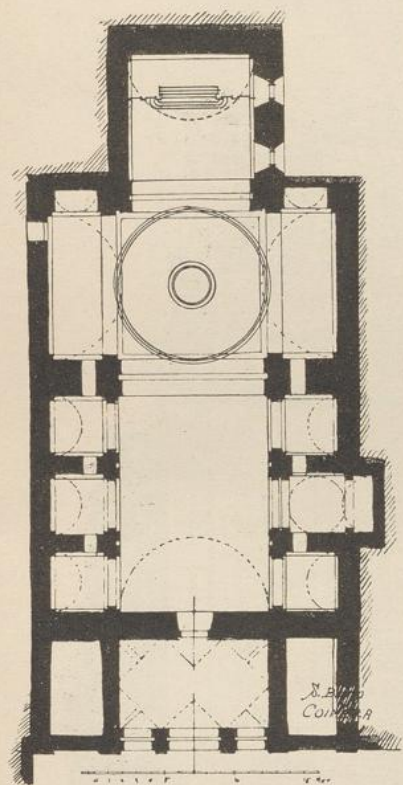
Grundriss von S. Bento zu Coimbra.
